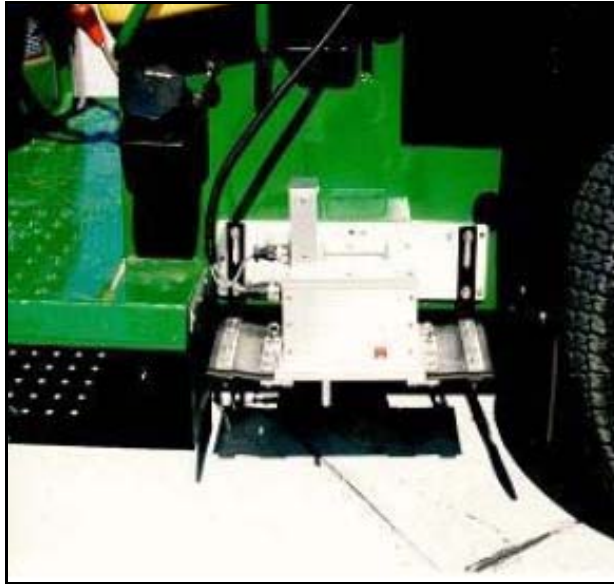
Detalle de la instrumentación del perfilógrafo de bajo peso.
